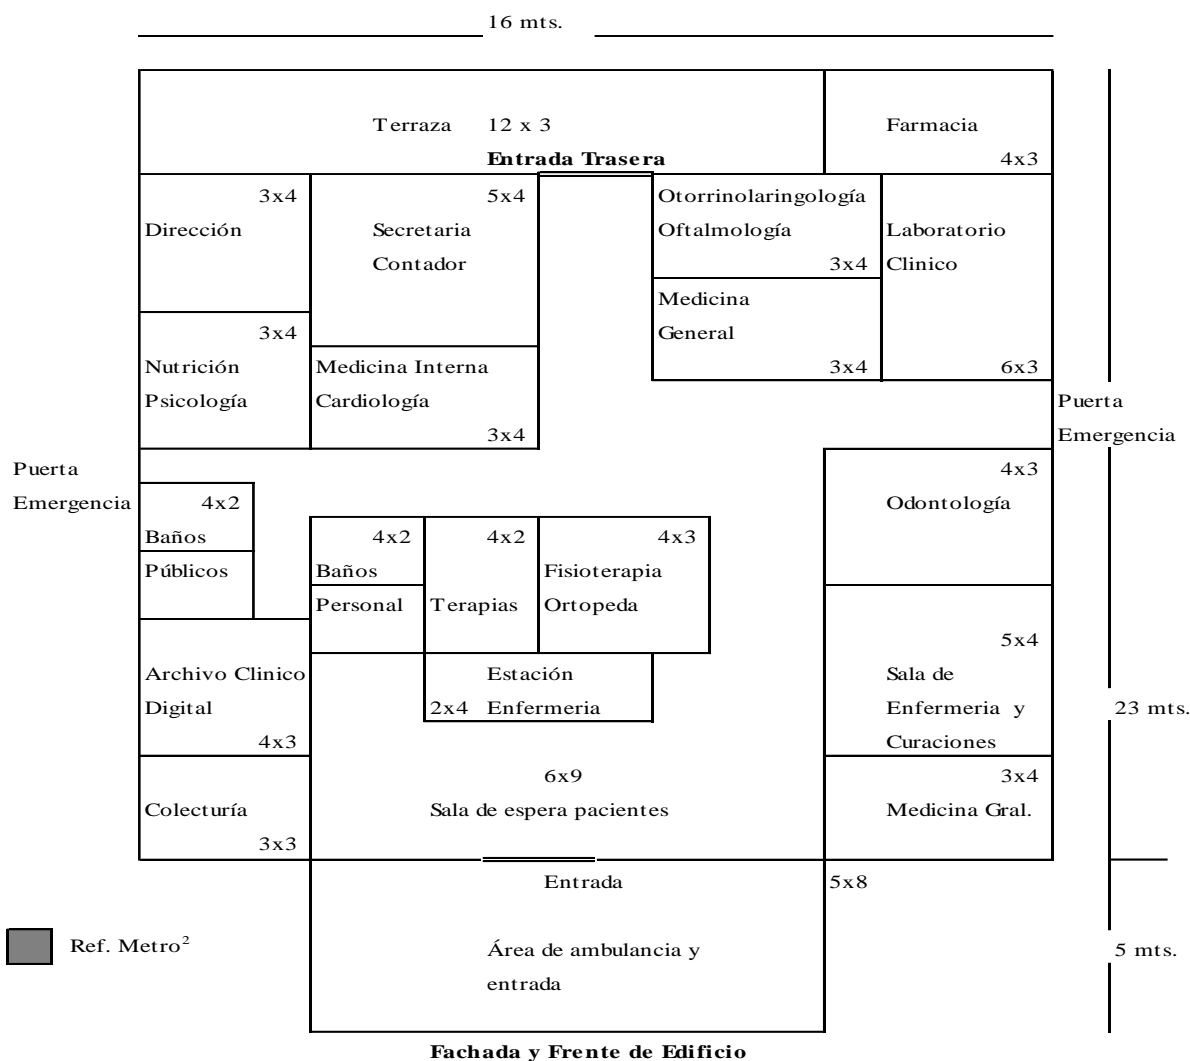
Distribución en Planta Propuesta de Nueva Clínica FMO
